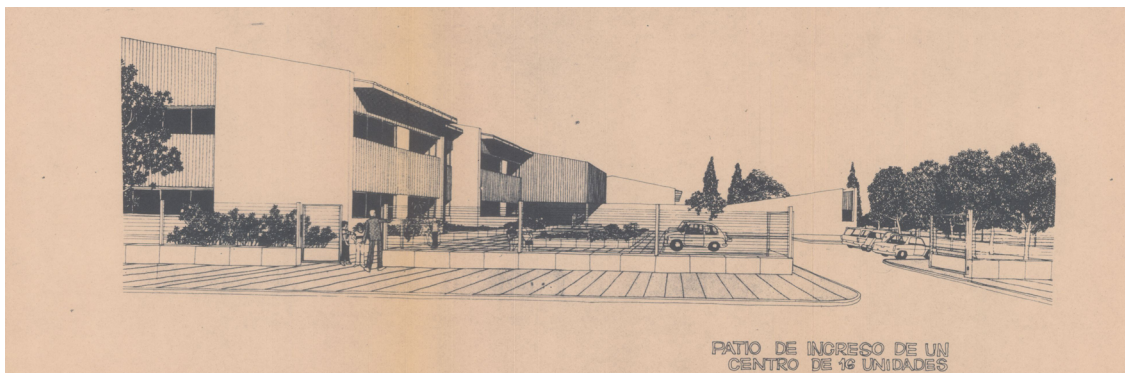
Imagen exterior "proyecto tipo 02" Plan de Urgencia Galicia
